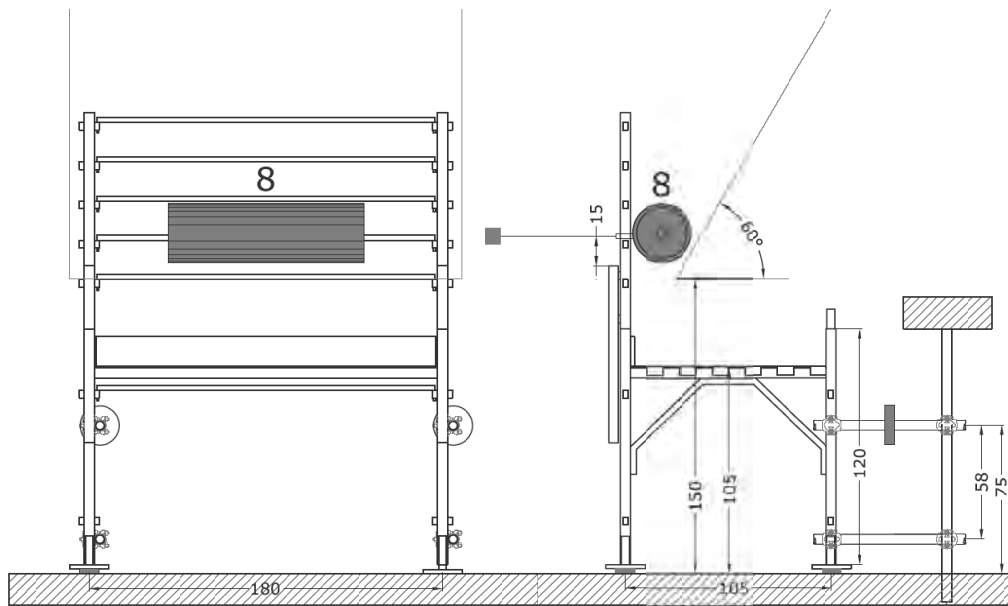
Prova d'impatto con rullo cilindrico sul corrente - Schema CS1
